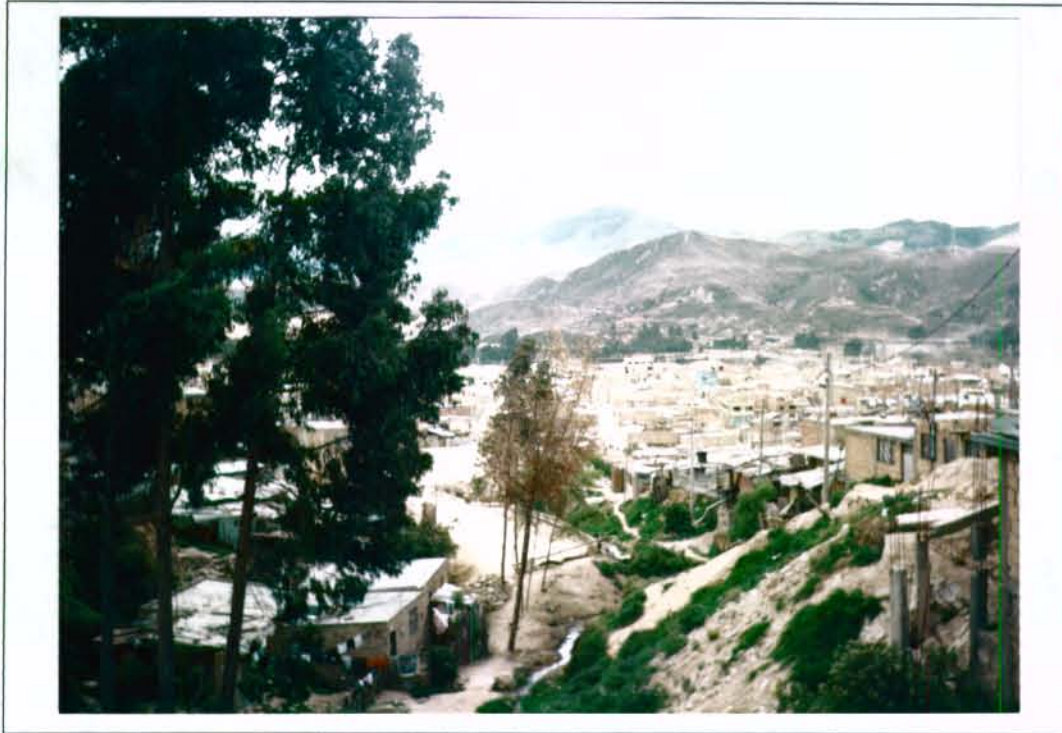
Vista desde una de las zonas más altas, hasta donde hay fácil acceso, hacia el sur, a la altura de la calle 52 Bis Sur. Se observan numerosas grietas de tracción en la corona de los rellenos.
